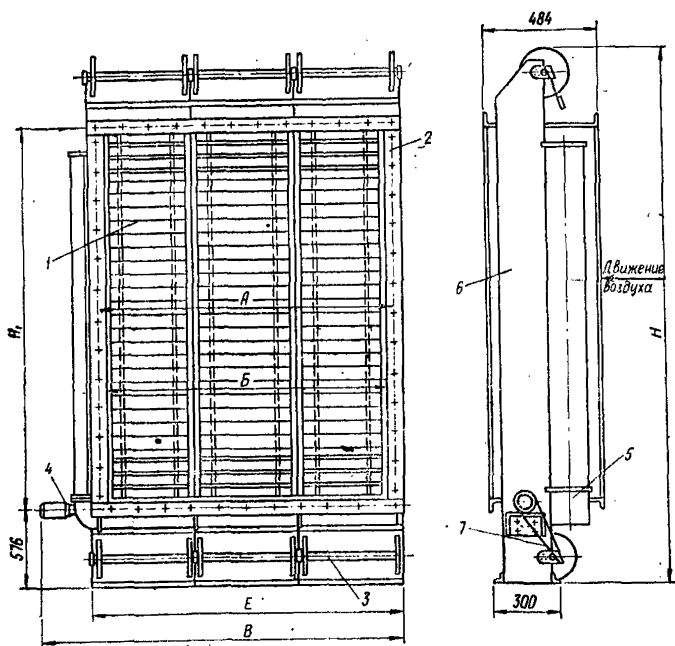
Габаритный чертеж фильтра ФРП (ФРПА, ФРПБ)
